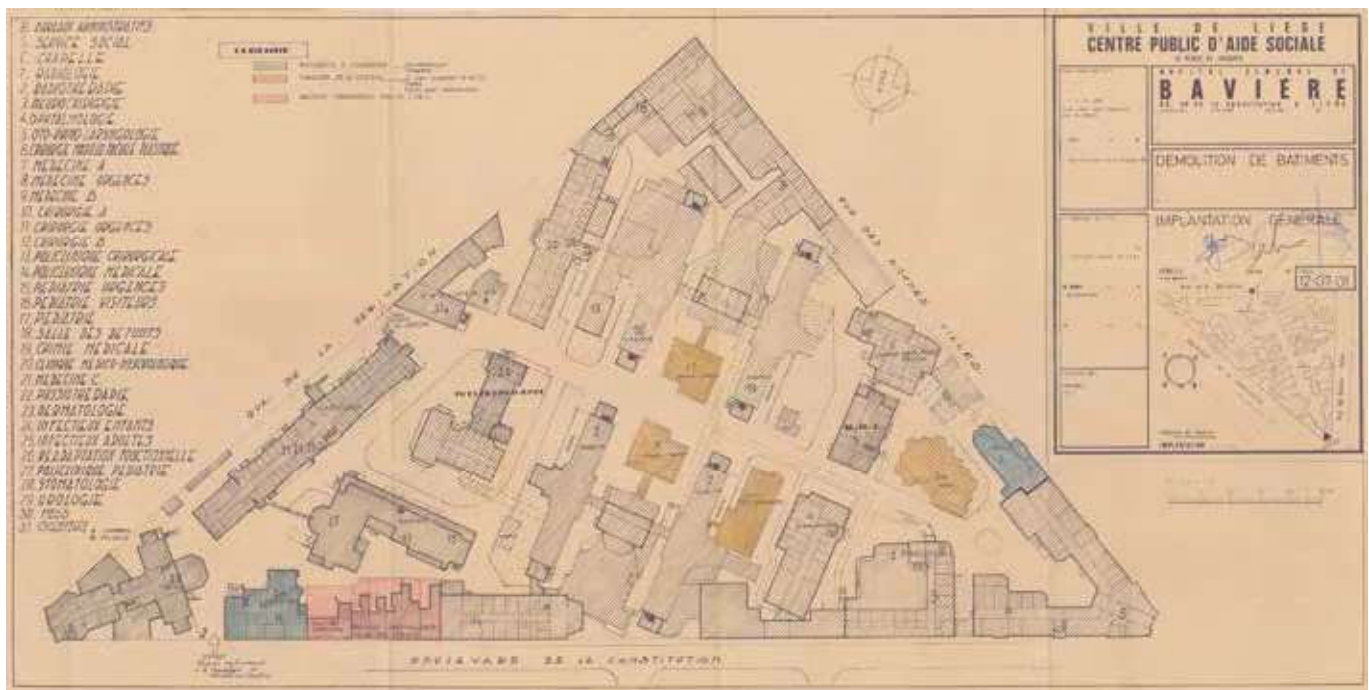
Labye, F. (1989). Plan de démolition. ACPASLg. BAVIÈRE, Caisse 24. Bte non-numérotée.
